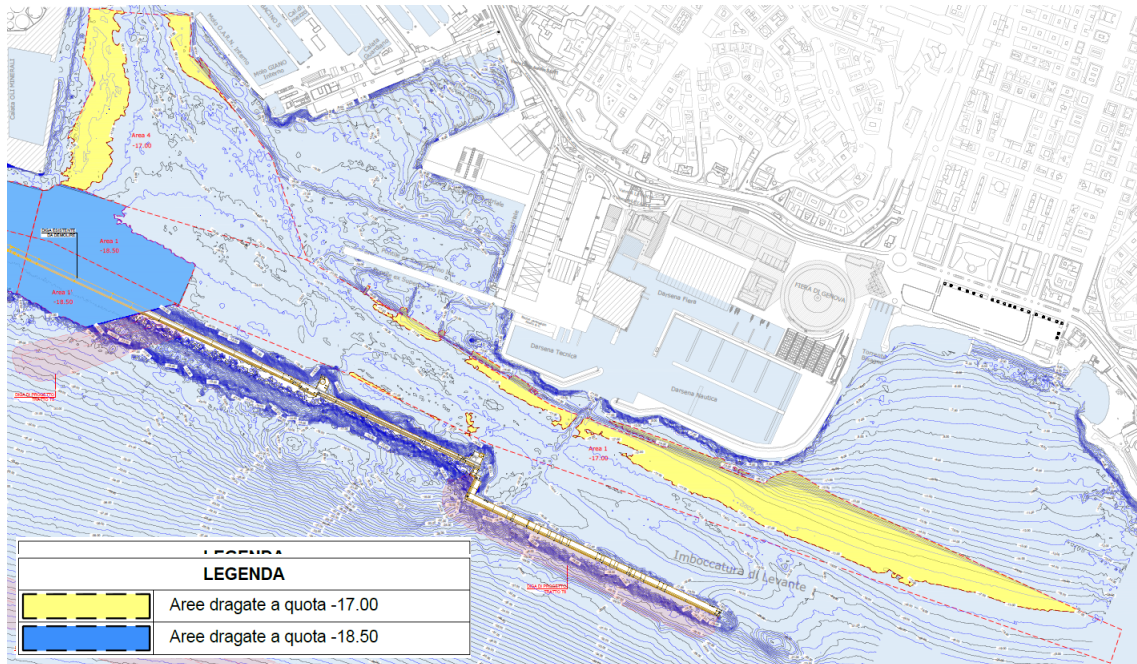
Dragaggio: Bacino di Sampierdarena (-18.5 m lmm) / Avamporto e imboccatura di Levante (-17.0 m lmm).
